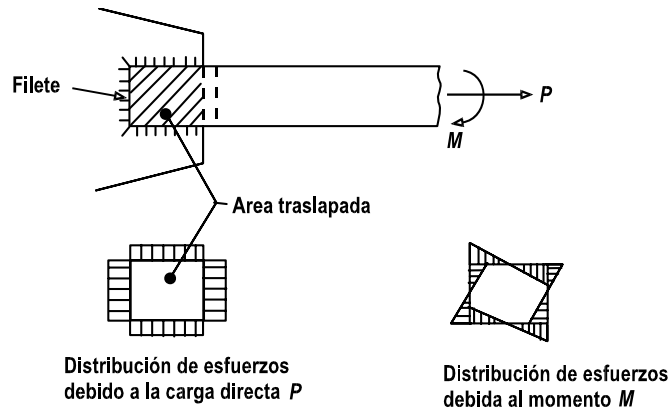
Esfuerzos en gargantas de soldadura
